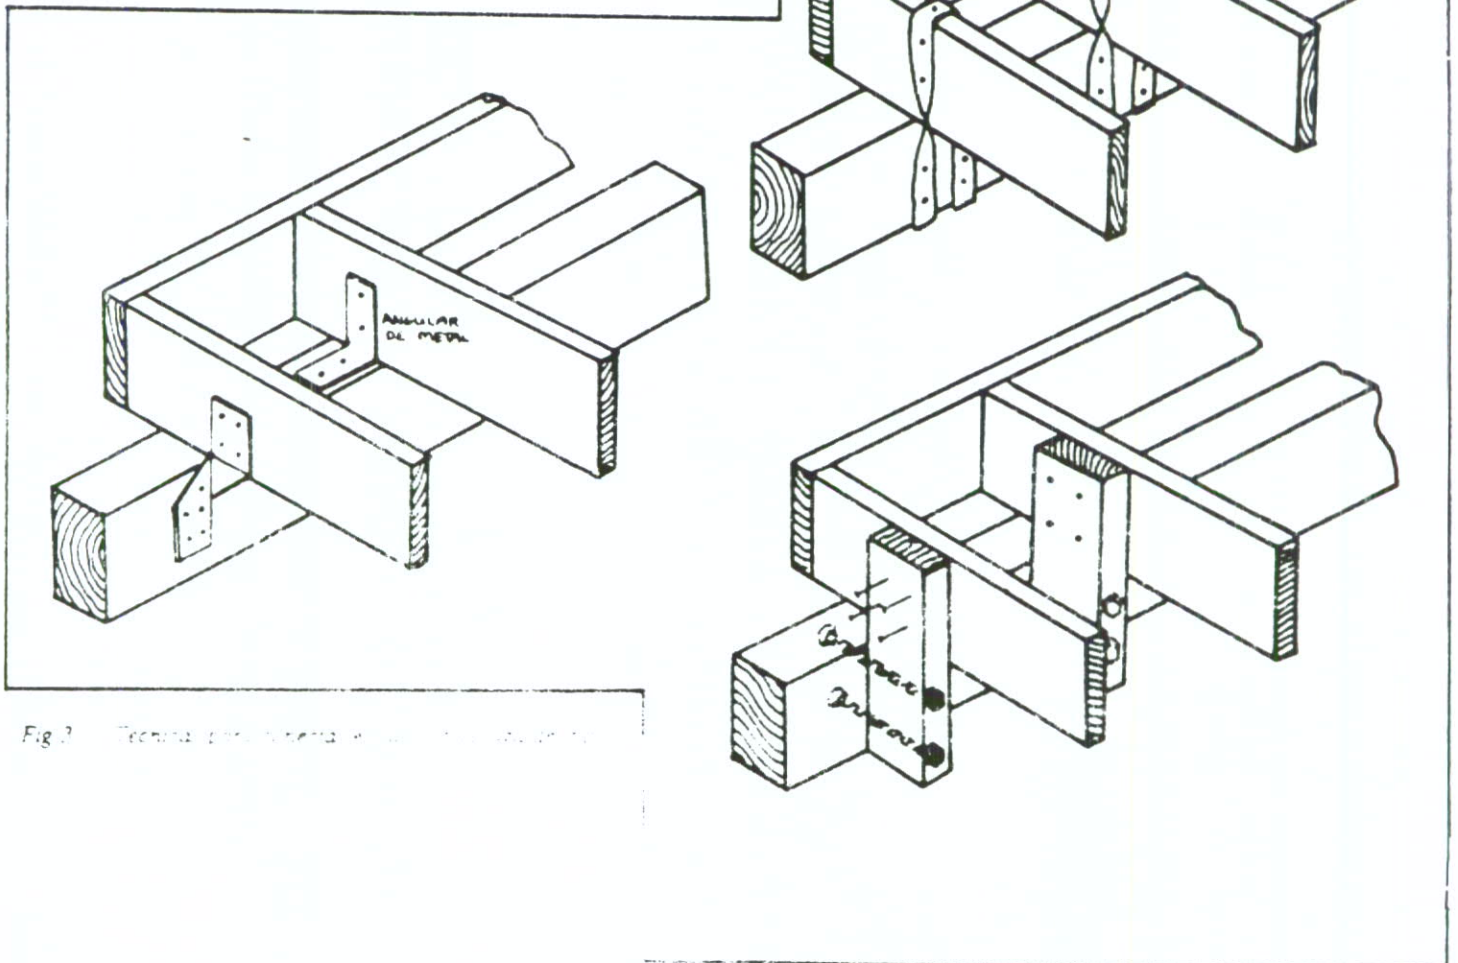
Técnica para conectar el piso de madera a una columna de mampostería.
